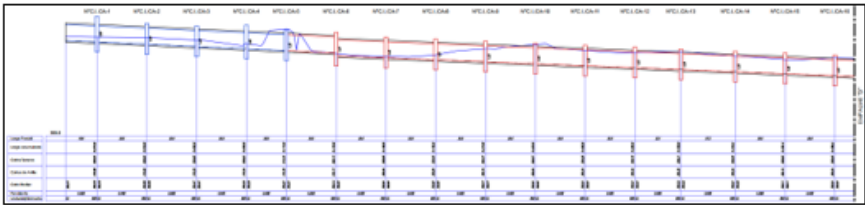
Perfil longitudinal y obras proyectadas sobre el canal.
